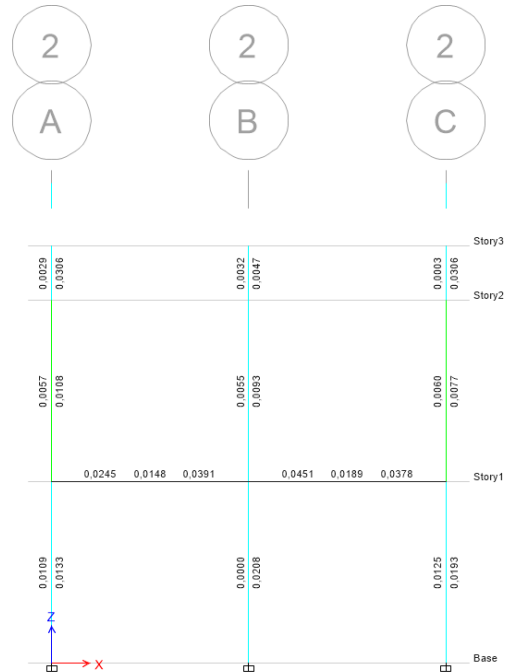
Acero requerido para corte vista en planta del nivel 1
